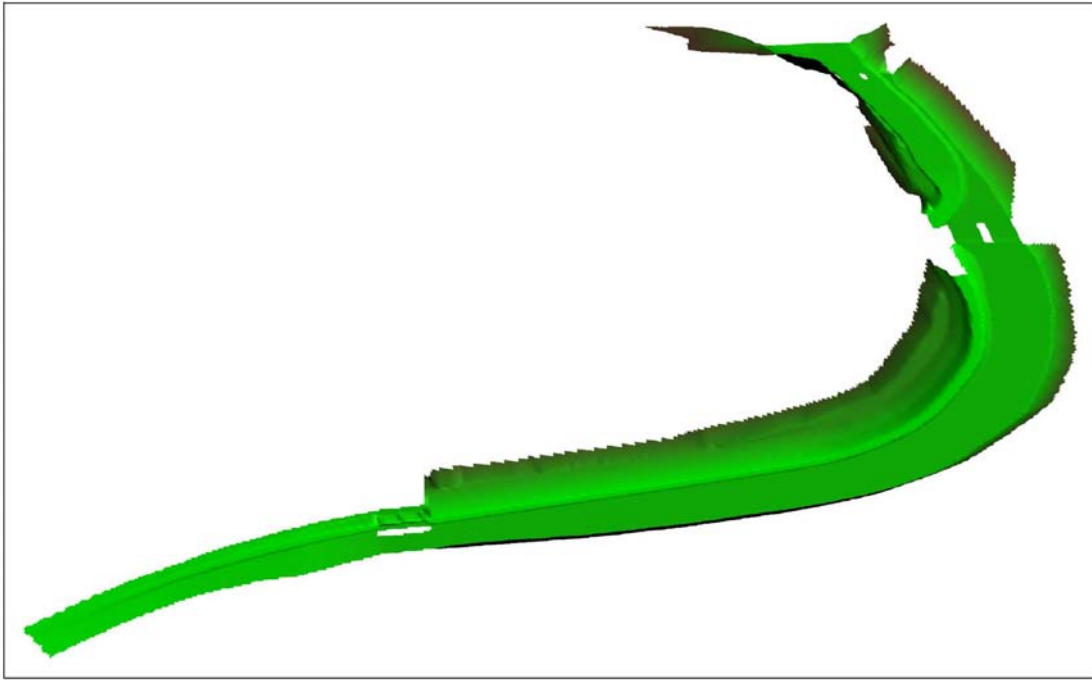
Ricostruzione prospettica 3D vista da valle del tratto modellato.
